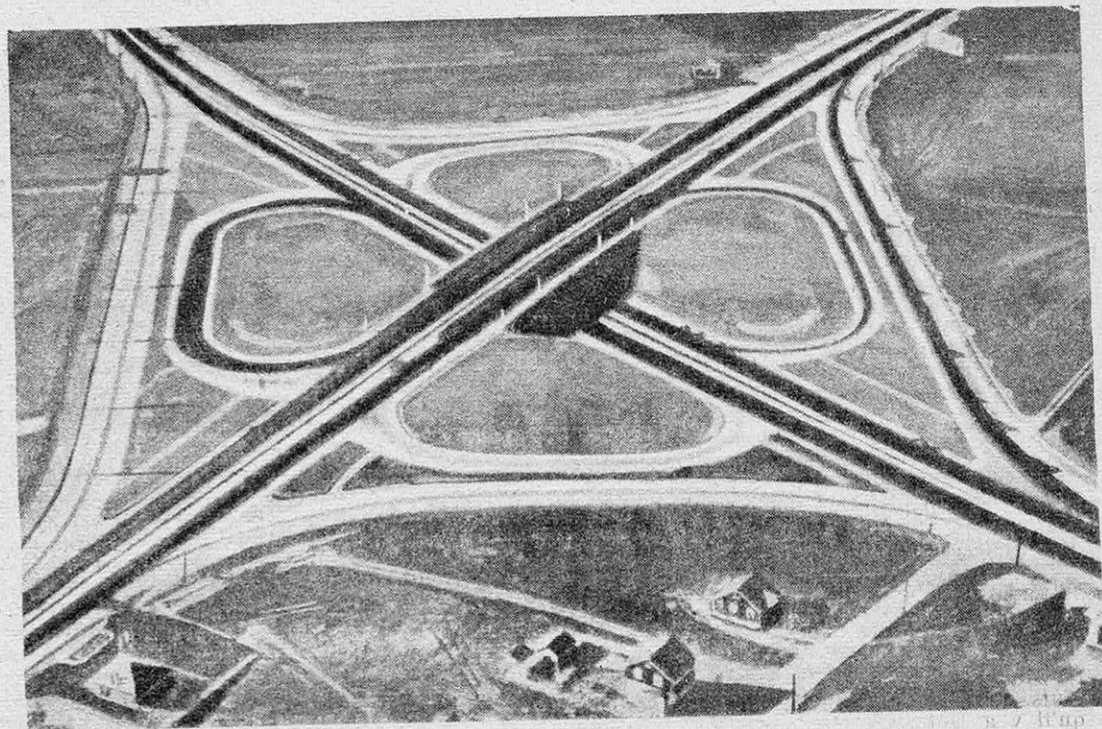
UN CROISEMENT EN « FEUILLE DE TRÈFLE » PRÈS DE WOOD BRIDGE (NEW JERSEY)
